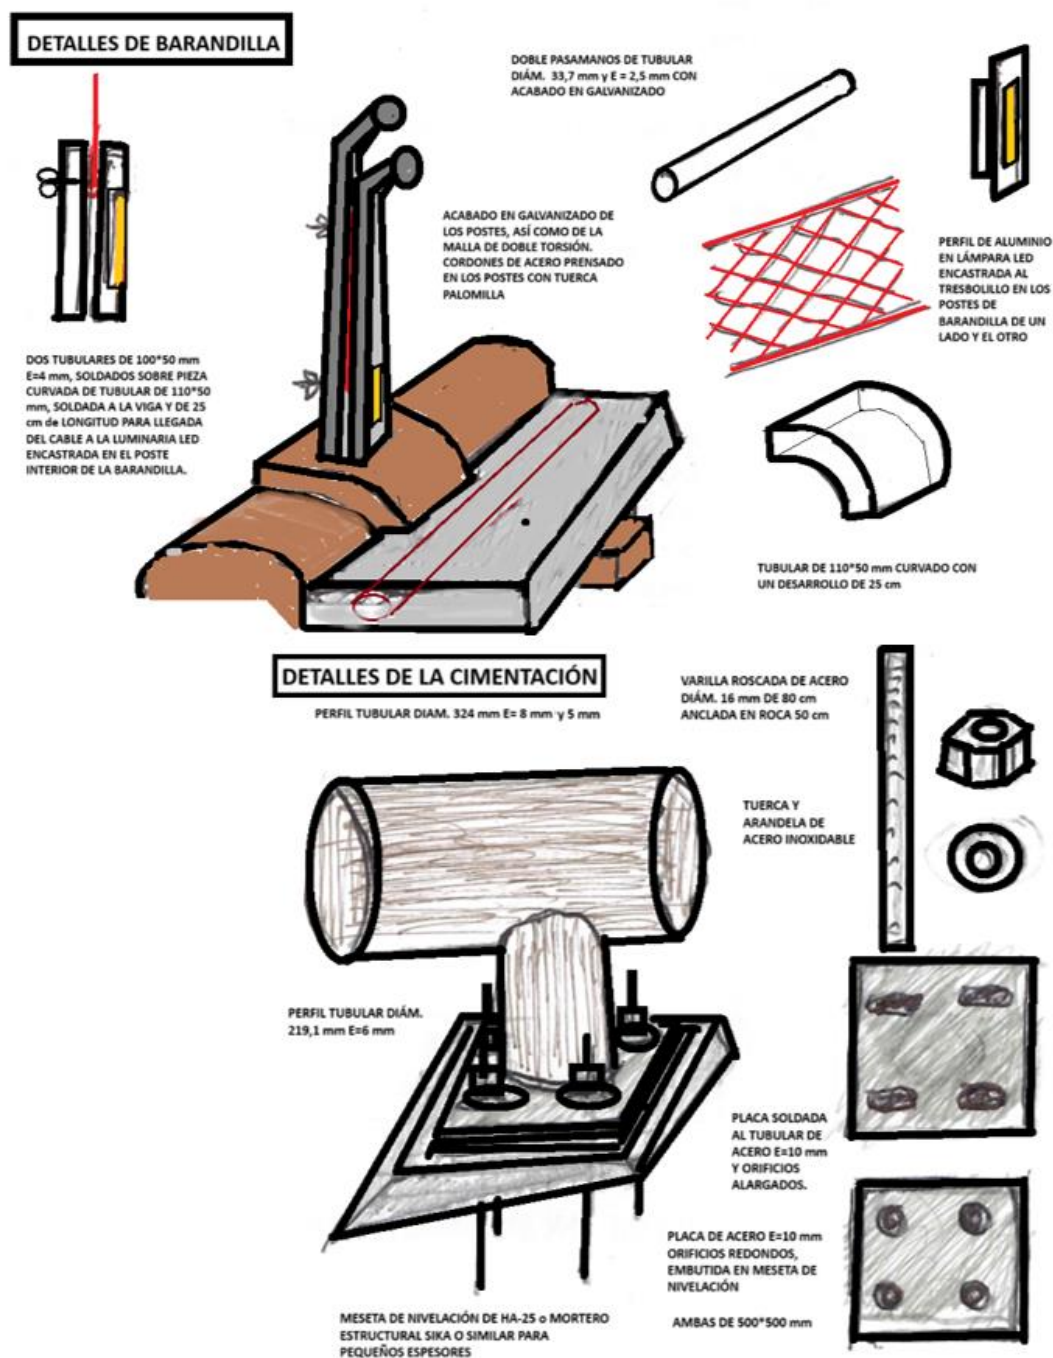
Croquis 3D de las barandillas y sus elementos y de la cimentación de los caminos de pasarelas
